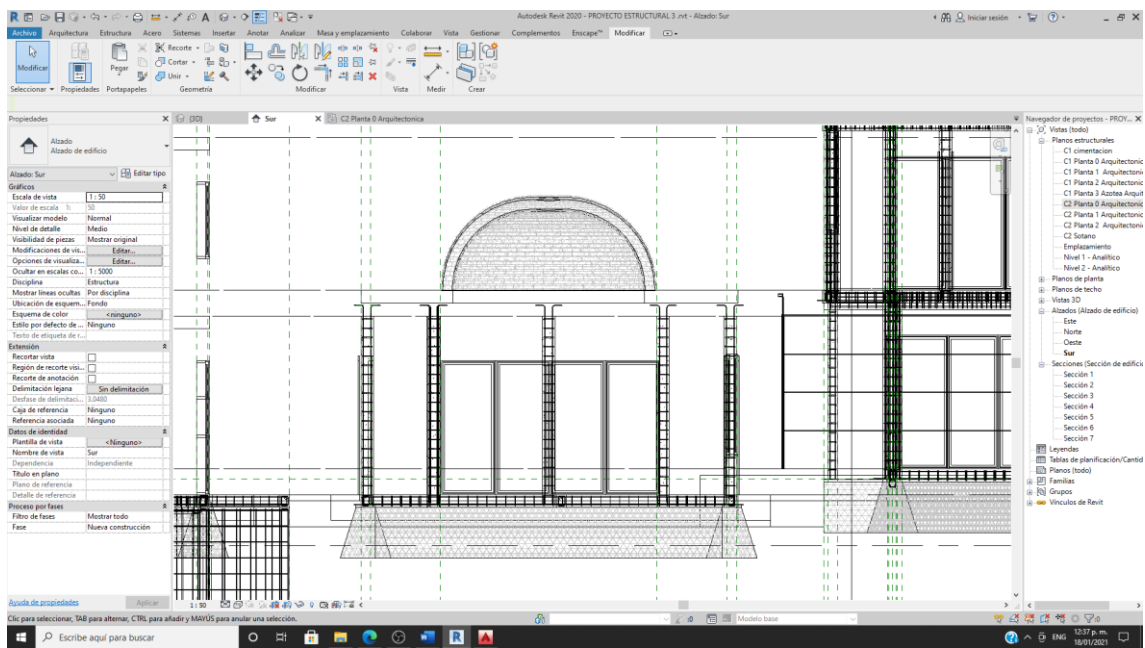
Estructura armada en fachada principal del oratorio. Fuente: (Elaboración propia Cajica, J. 2020)
